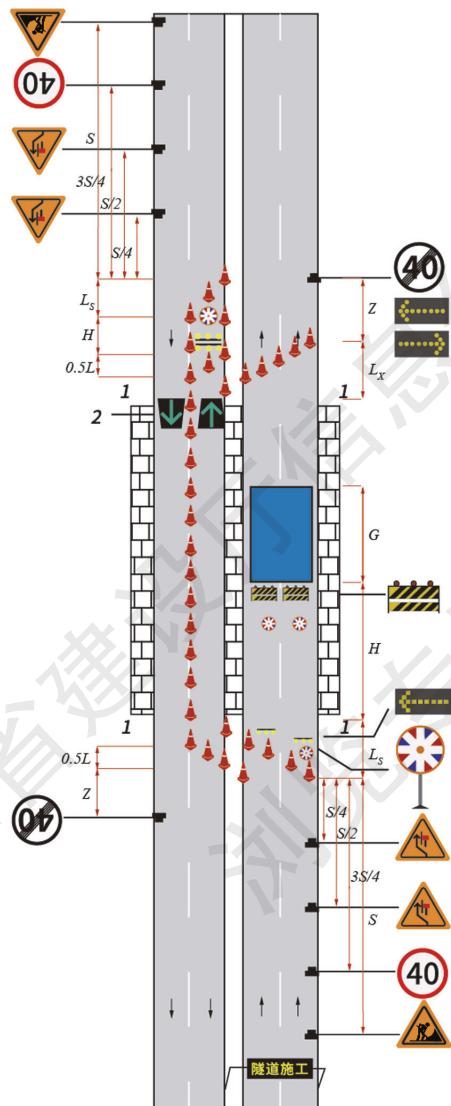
隧道双洞单向全封闭时养护作业控制区布置示意
